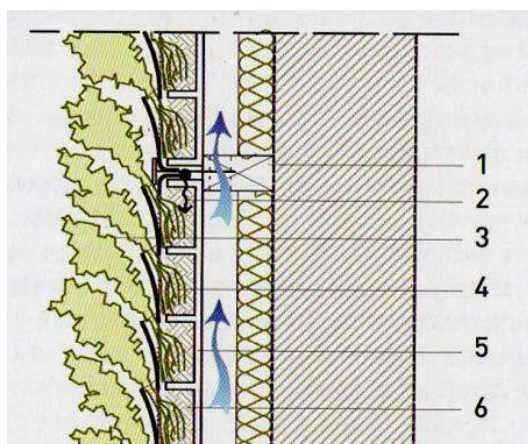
Corte explicativo de uma Paredes Viva de Substrato ligeiro. Retirado de: (Garrido, 2011)
